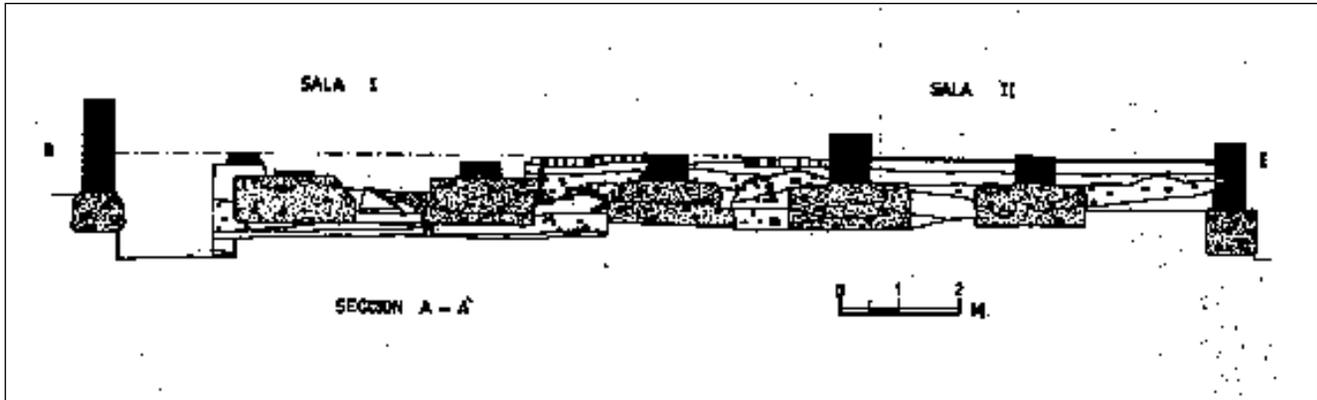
Sección A - A' de los alzados conservados y de las cimentaciones de la casa n° 2 de la Carretería.
